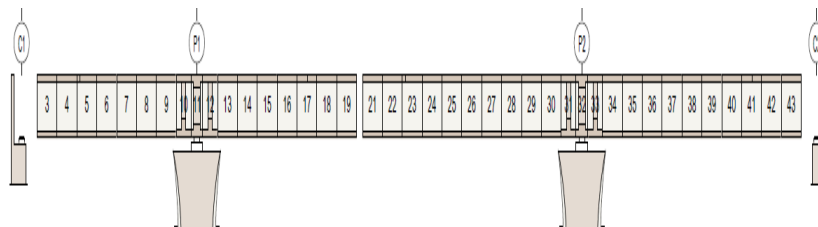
Construction sur cintre du tablier proche à la culée 1
